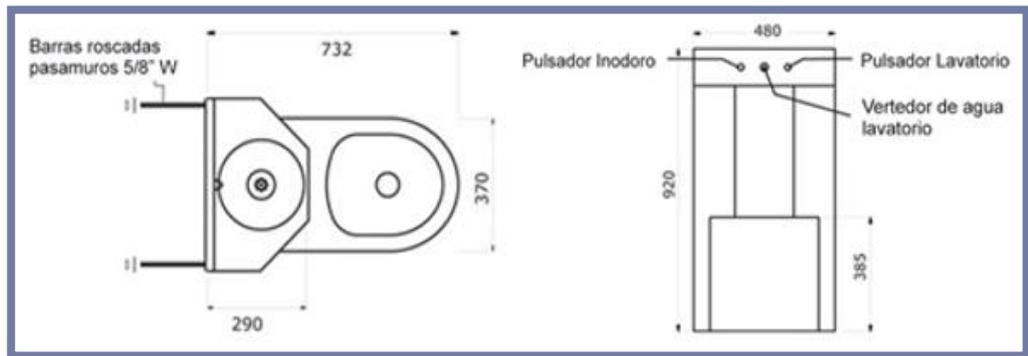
Cuevo Monolítico. Vista en Planta y Frente.
